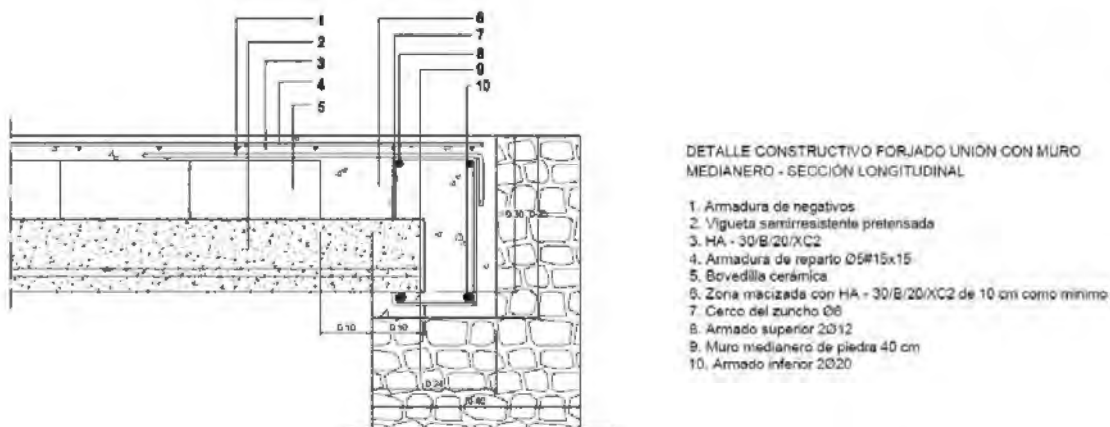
Detalle constructivo forjado – muro medianero. Fuente: propia.
